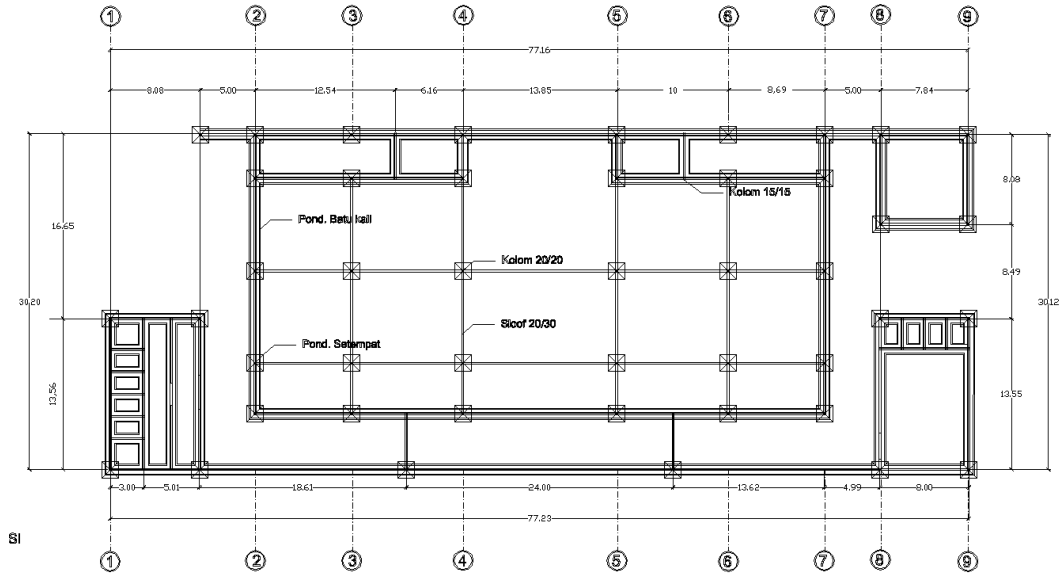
Rencana Pondasi Kantor Pengelola Pabrik
